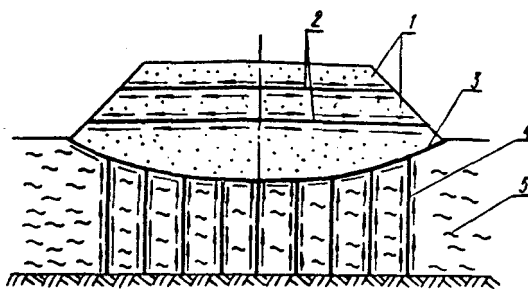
Конструкция насыпи с дренирующими прослойками из текстильного материала: 1—насыпь из переувлажненного грунта; 2—дренирующие прослойки в теле насыпи; 3—дренирующая прослойка в основании насыпи; 4—вертикальные дрены из текстильного материала; 5—слабое основание.
